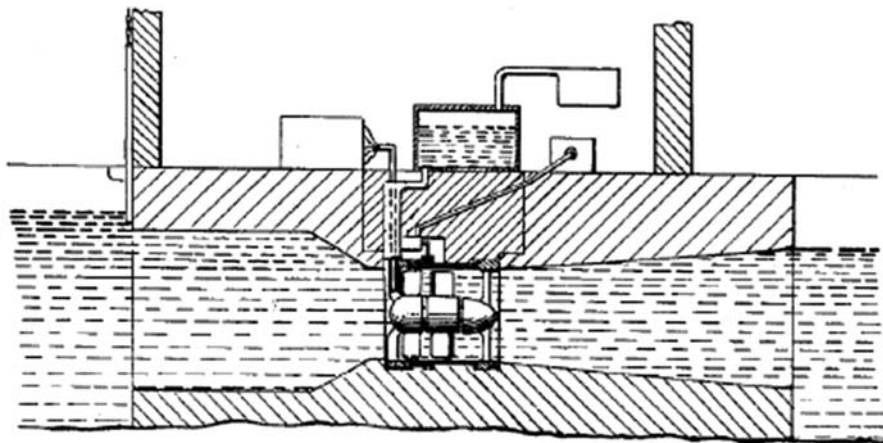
Corte longitudinal de una planta hidroeléctrica con turbina de Guimbal.
